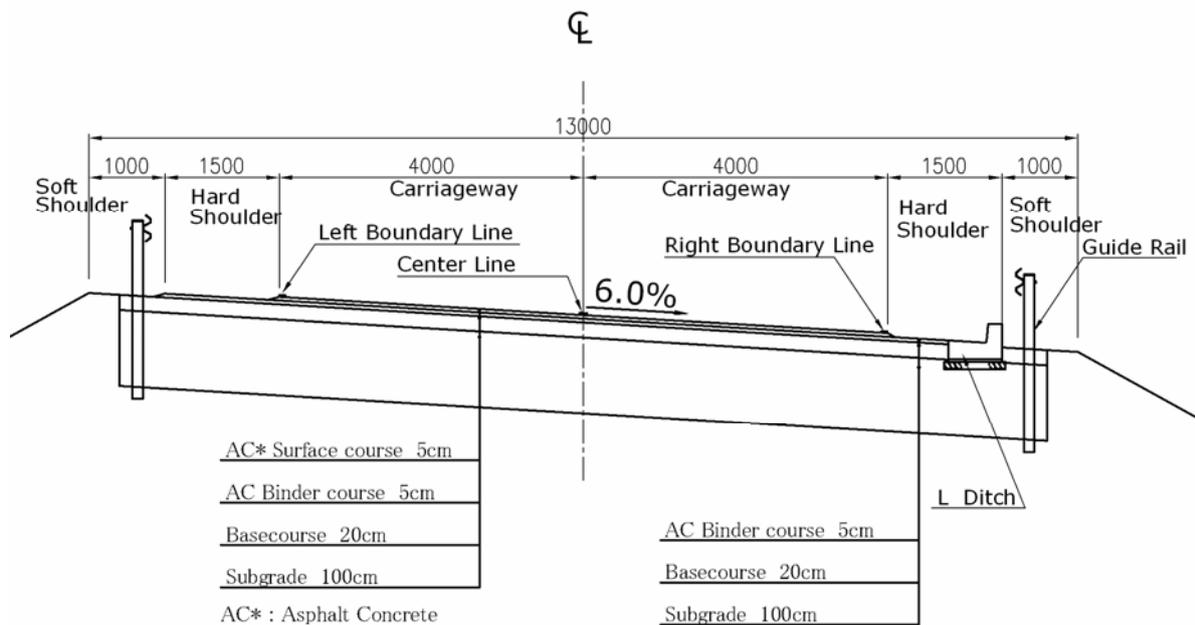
カアカ橋取付道路標準断面図
